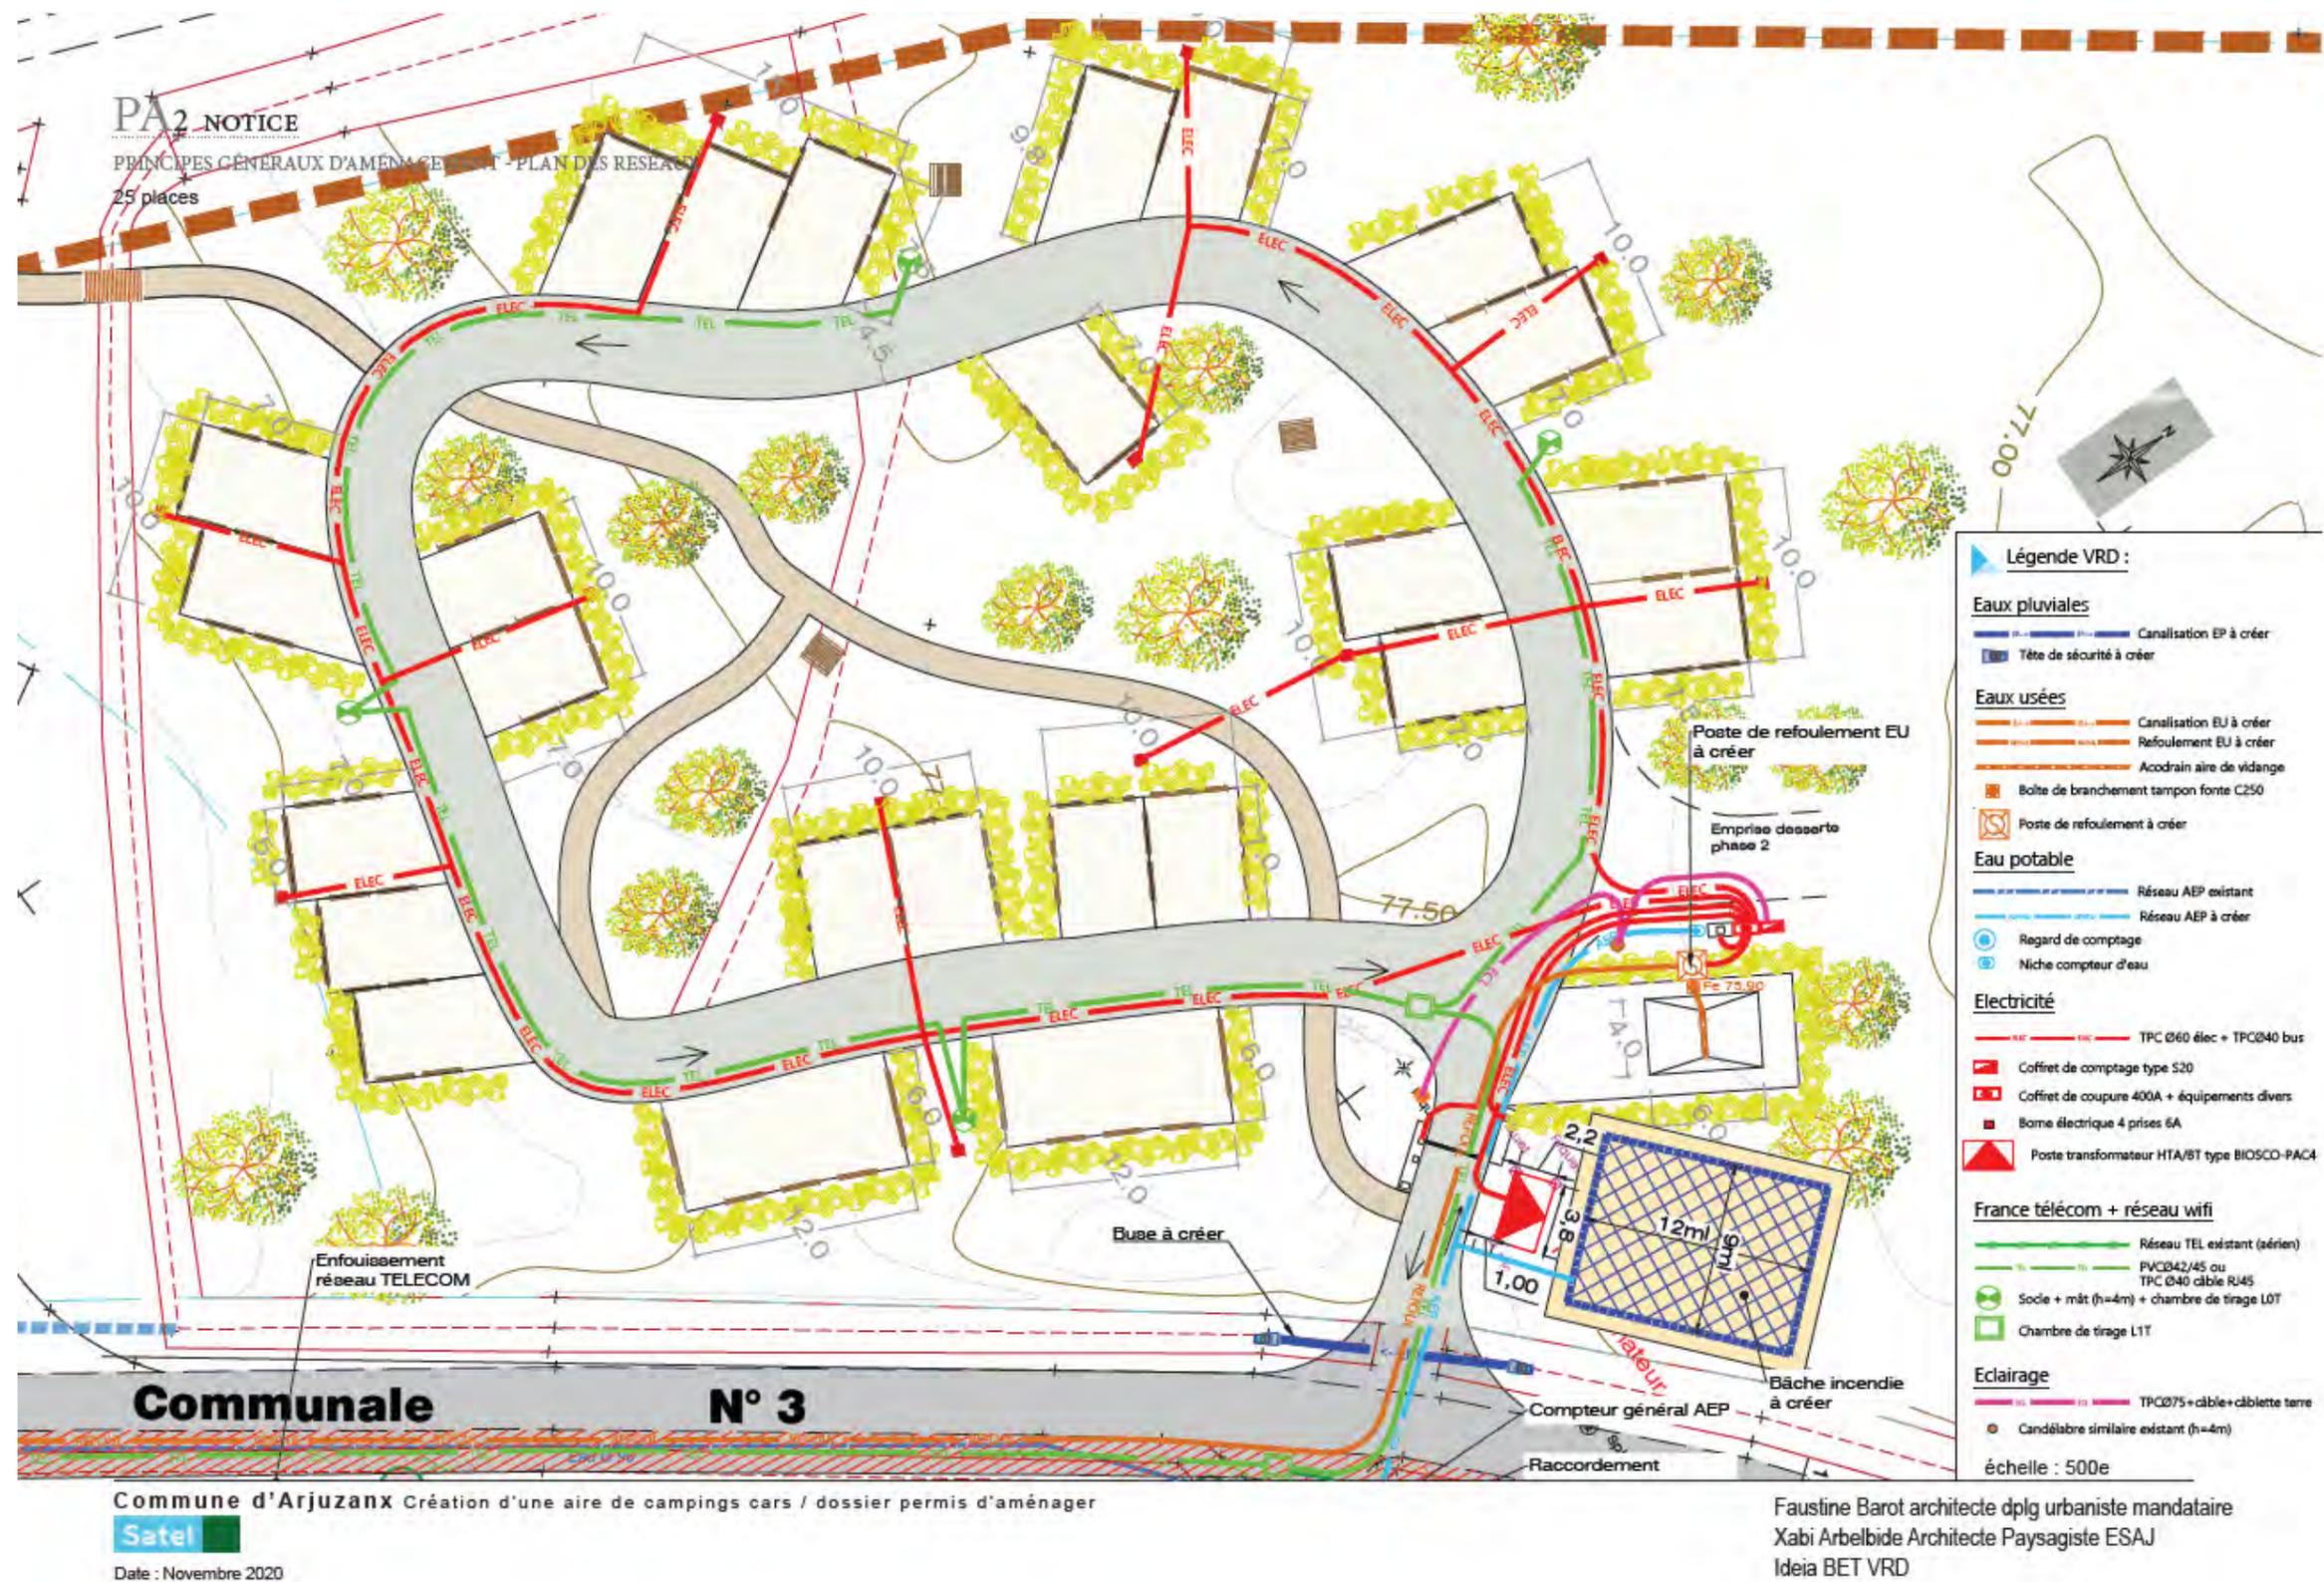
Principes généraux d'aménagement – Plan des réseaux (11/2020)
